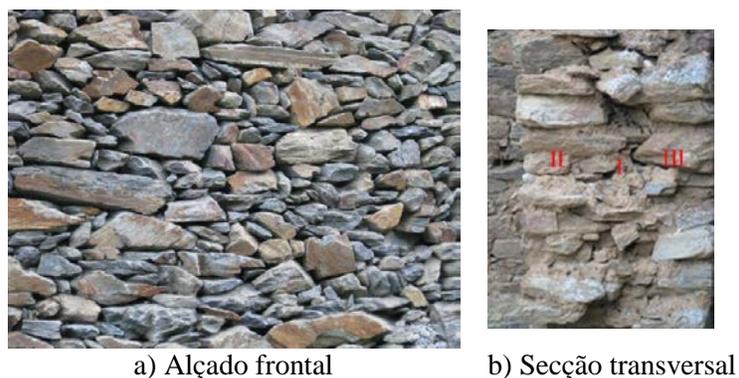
Detalhes construtivos de paredes de alvenaria de pedra de xisto
